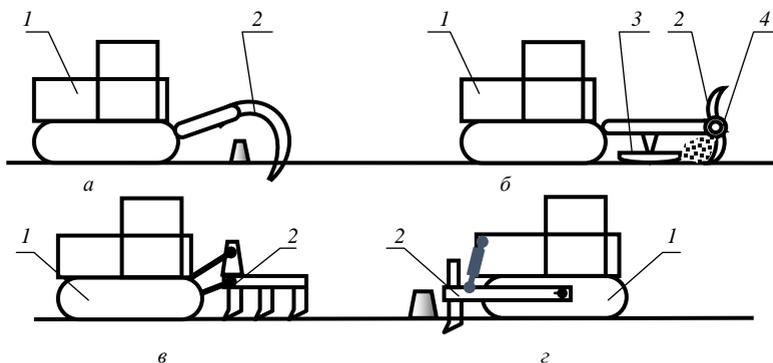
Основные схемы корчевателей, корчующих поступательным движением машины: *а* – крюковой; *б* – роторный; *в* – корчевальные грабли; *з* – корчеватель, навешенный спереди: 1 – машина базовая; 2 – рабочий орган; 3 – лыжа опорная; 4 – муфта предельного момента
